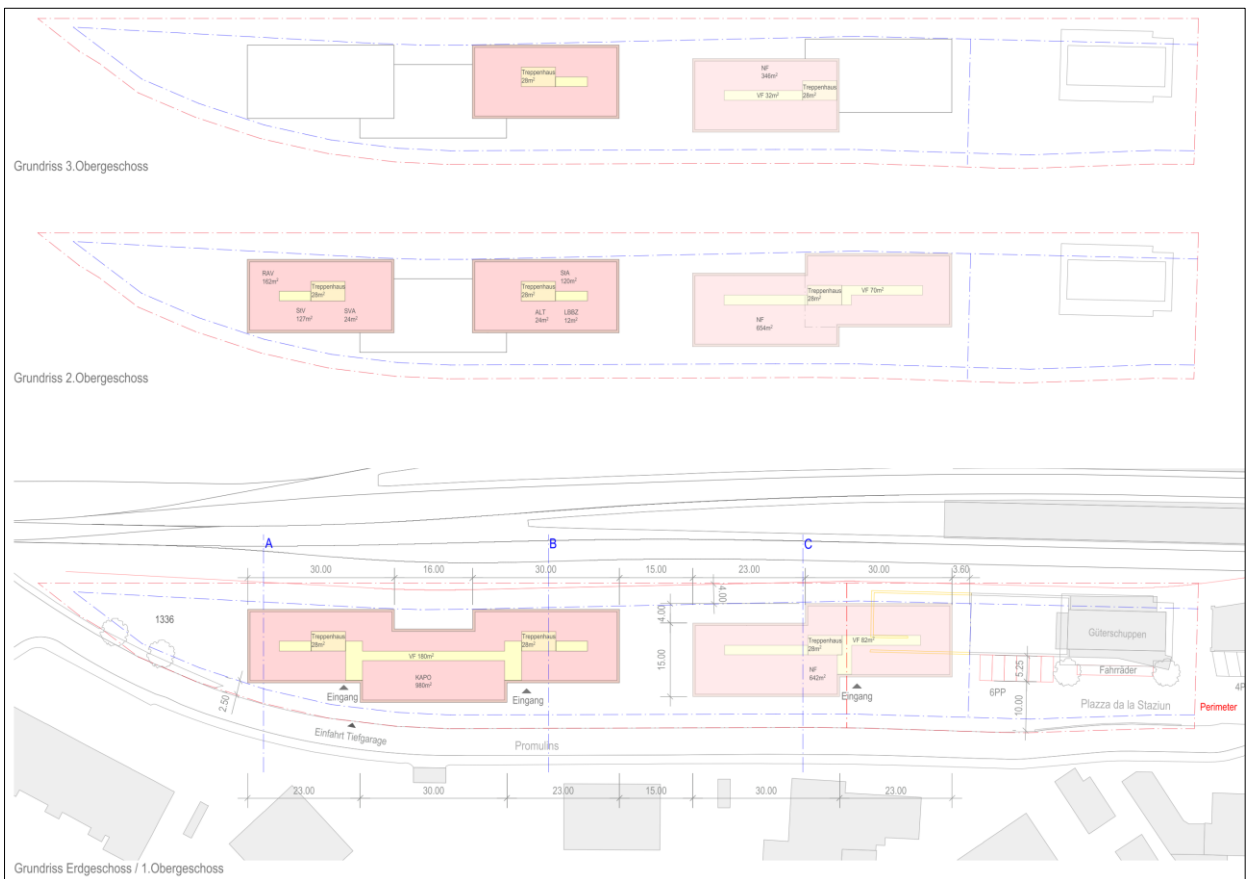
Grundrisse, Machbarkeitsstudie (nicht massstäblich), Liesch Ott Architekten
